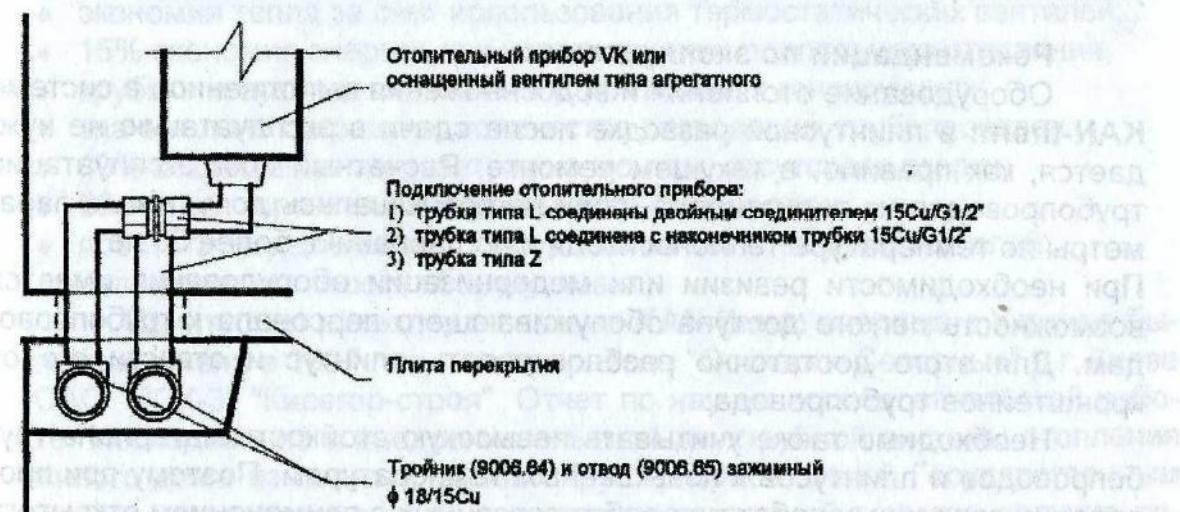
Подключение отопительного прибора при разводке под перекрытием с горизонтальным расположением труб.
